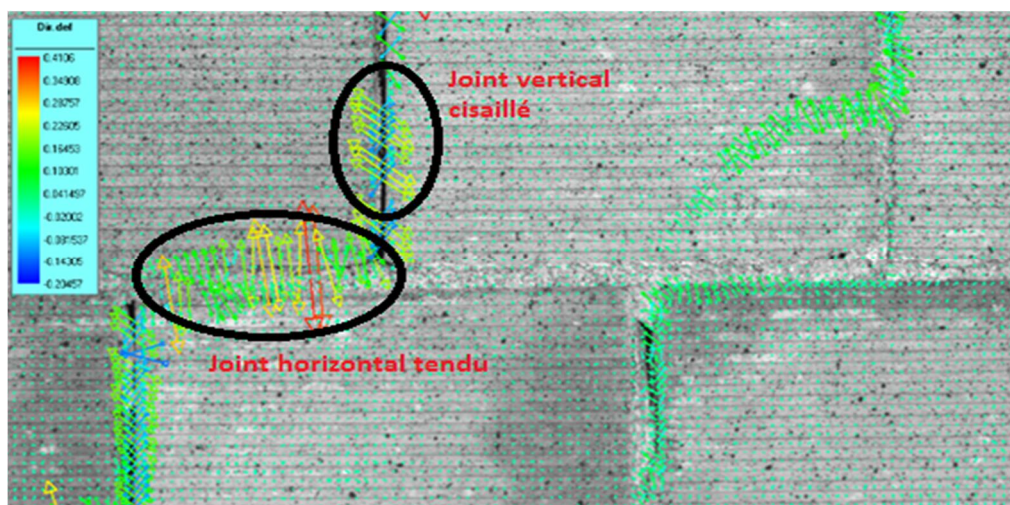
1 : Fissuration du panneau du spécimen PC1 d'après l'image (d) de la figure II.4.2.
